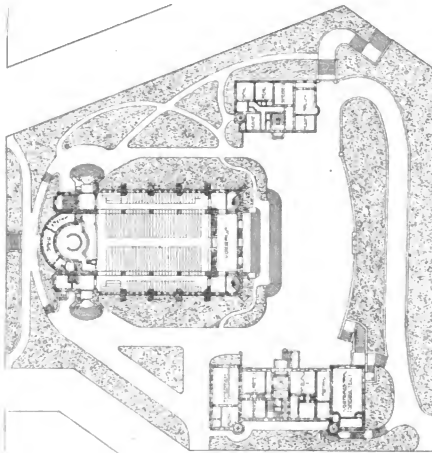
Plan zu einer Gemeindekirche in Stockholm.
